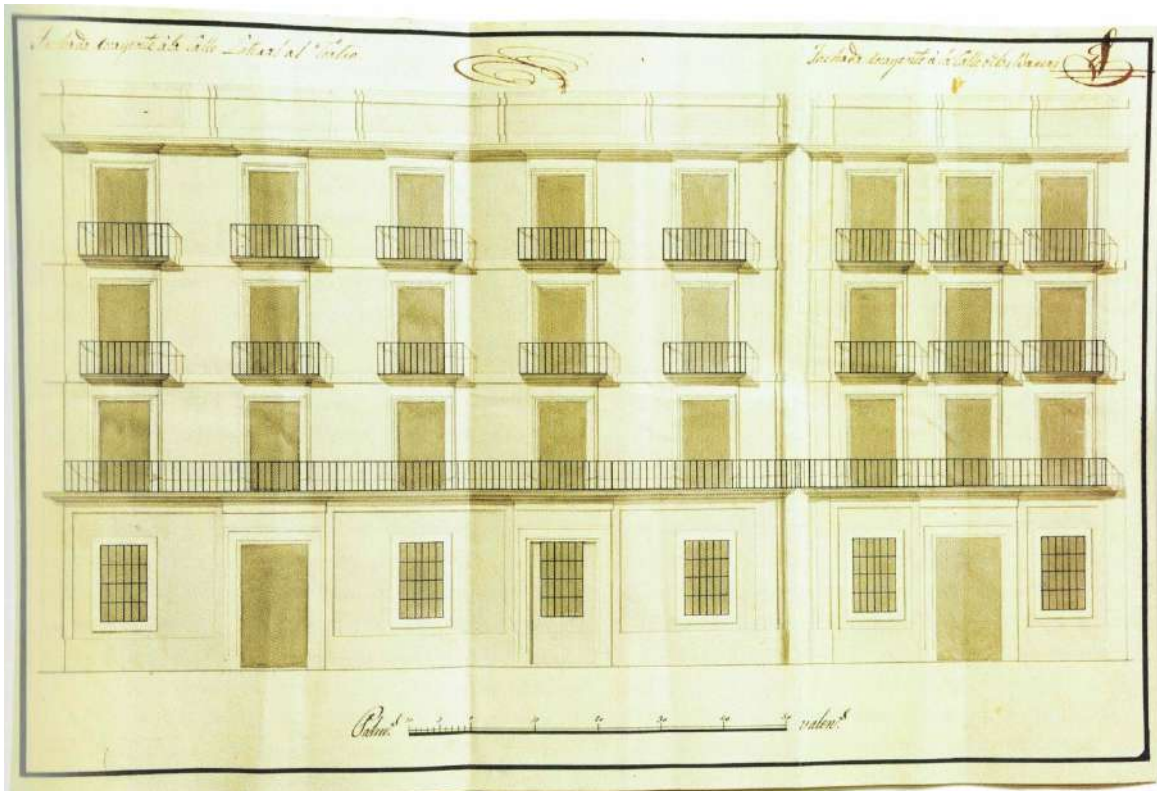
Fachada de una casa recayente a la calle lateral del Teatro, 1833
